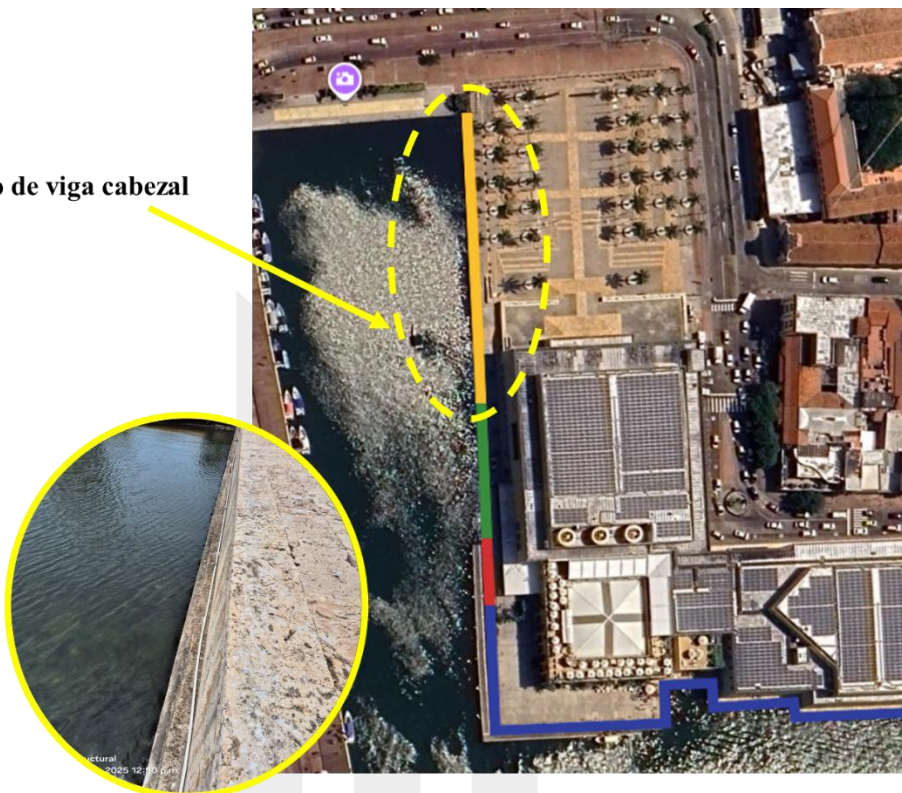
Ubicación de intervenciones de reforzamiento estructural en viga cabezal sector 1
